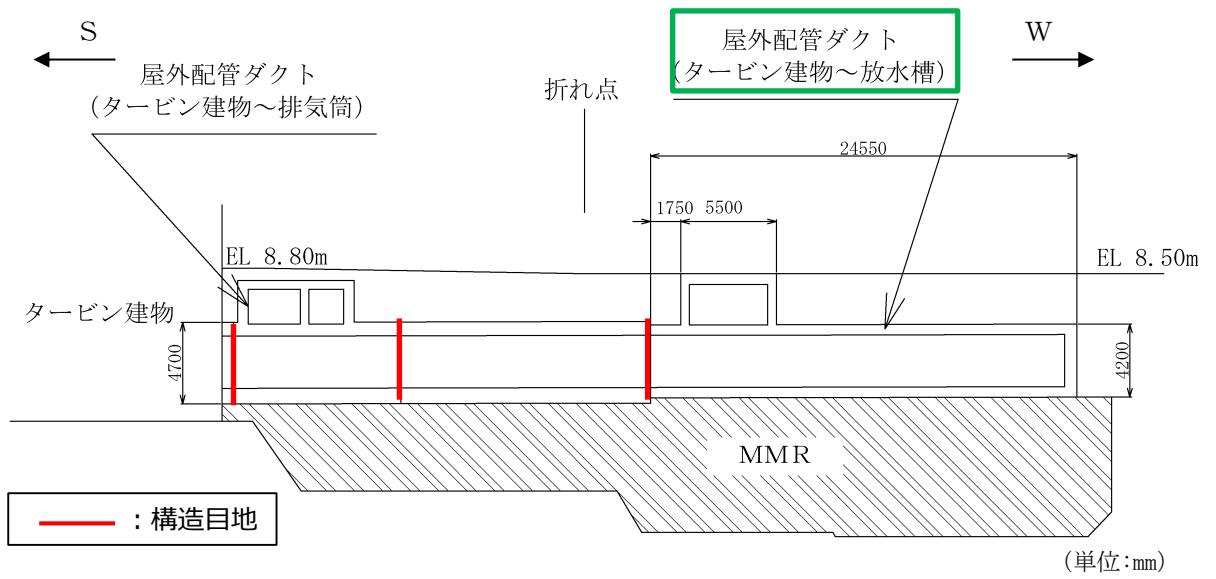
屋外配管ダクト (タービン建物～放水槽) 断面図 (D-D断面)
